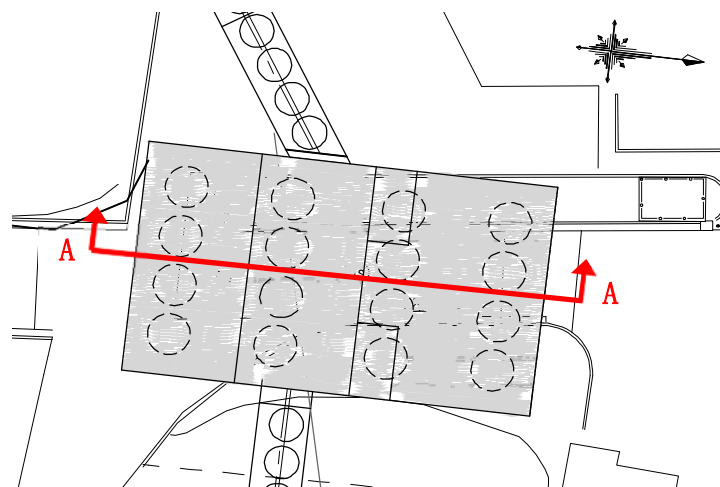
防潮扉 2 基礎 位置拡大図
